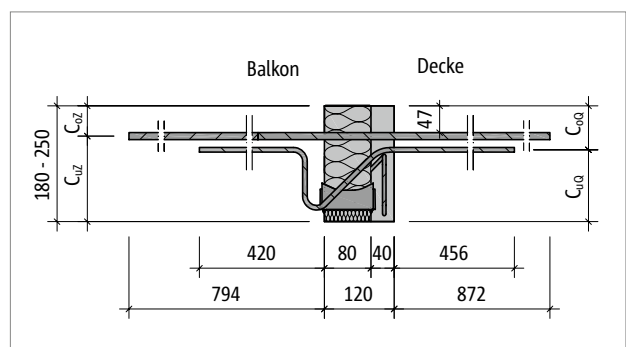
Schöck Isokorb® RT Typ K-M2: Produktschnitt
